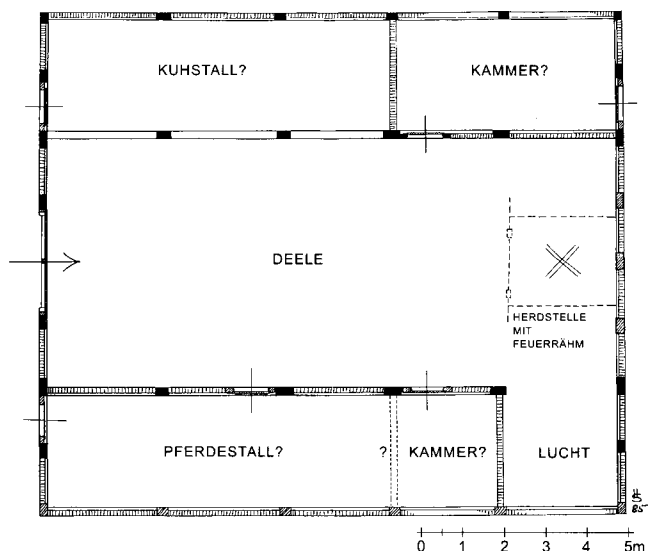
Schönemark (Stadt Detmold), ehem. Hof Klöpping Nr. 8. Bauernhaus (Großkötter), 1573 (j). Grundriss, rekonstruierter Zustand zur Bauzeit. Aufmaß und Zeichnung; Verf.
